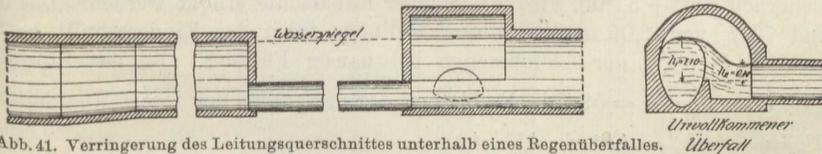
Verringerung des Leitungsquerschnittes unterhalb eines Regenüberfalles.
